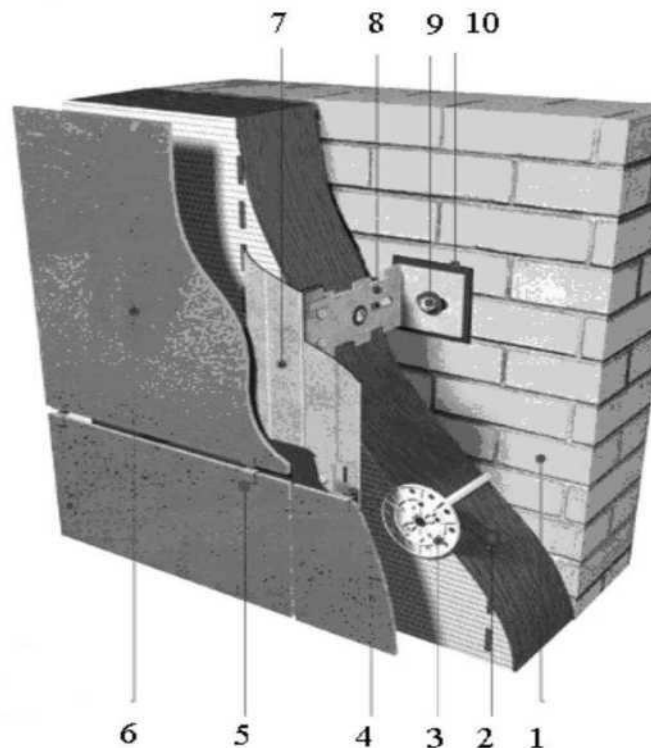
Конструкція навісного вентиляваного фасаду системи «Краспан» з видимим кріпленням: 1- цегляна стіна; 2- мінераловатний утеплювач; 3- тарілчастий дюбель; 4 - вітрозахисна плівка; 5- кляммір пофарбований; 6 - фасадна плита; 7- вертикальний профіль; 8- підвижний кронштейн; 9- анкерний кріпитель; 10 - прокладка
